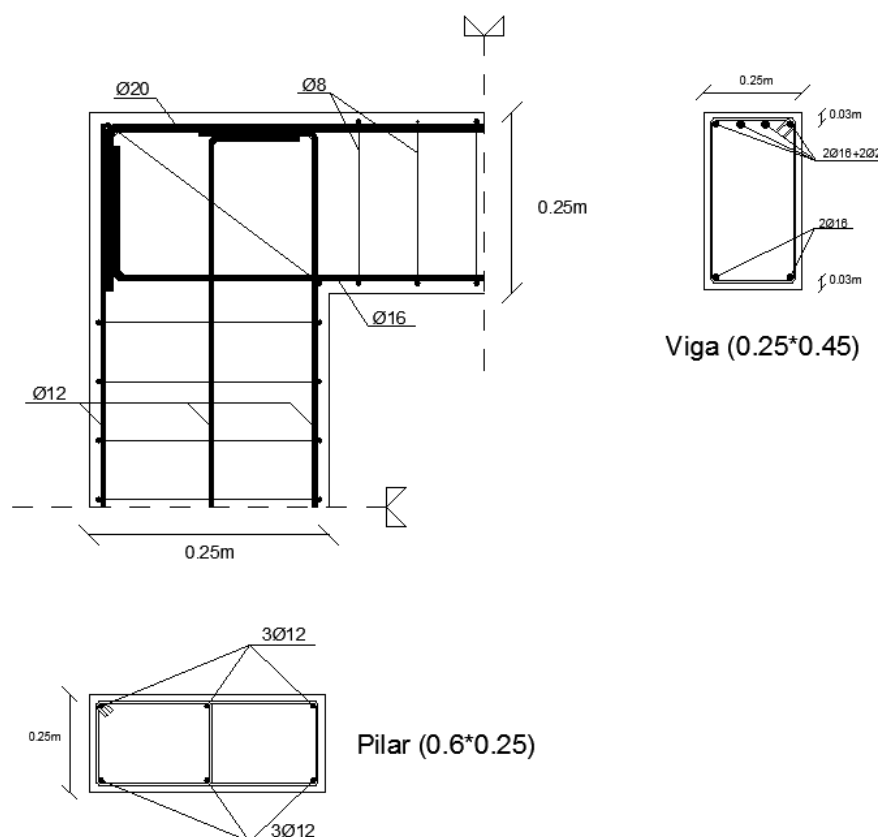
Pormenorização do nó tipo para o edifício
